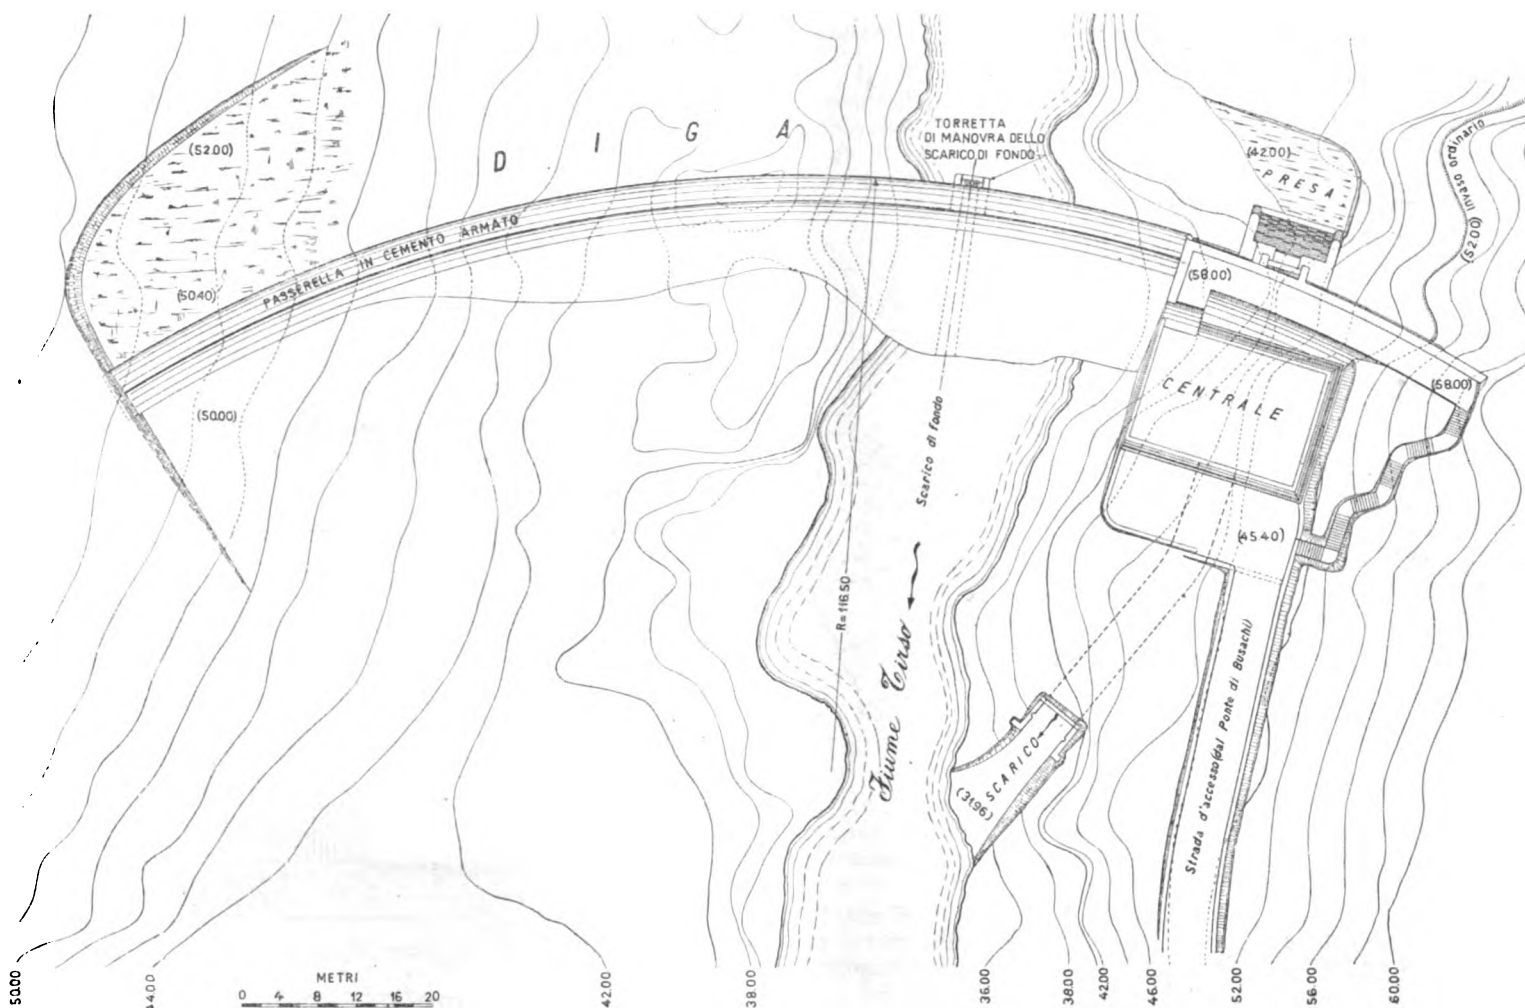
Planimetria generale dell'impianto di Busachi.
